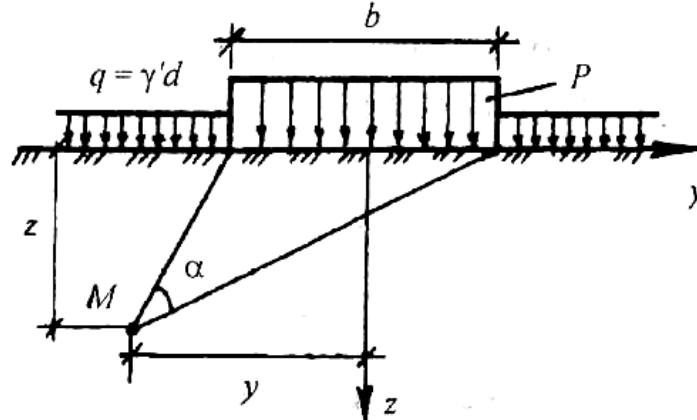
Расчетная схема для определения начальной критической нагрузки на грунт
